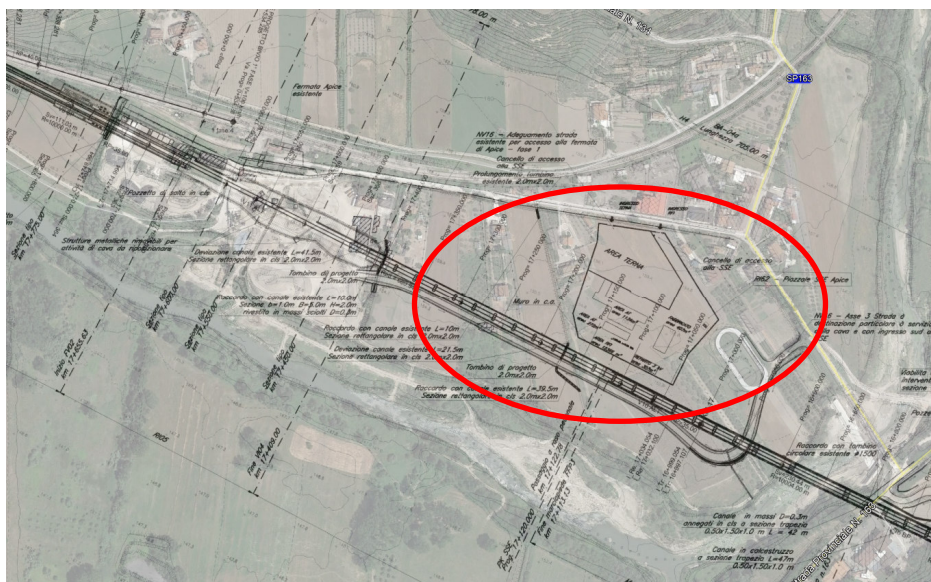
Individuazione su foto aerea dell'ambito di progetto interessato dalla prescrizione
